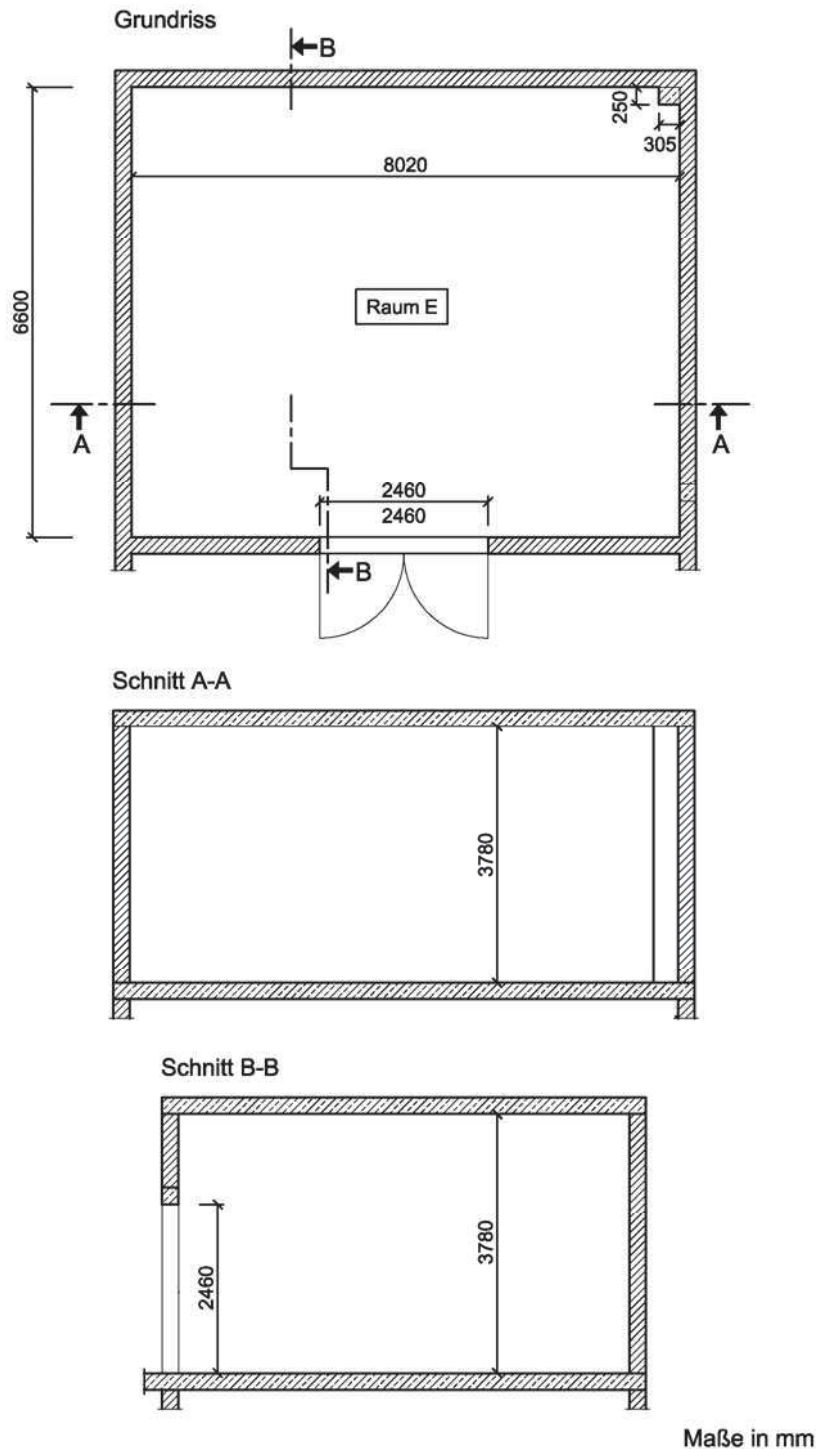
Grundriss und Schnitte des Hallraums.
